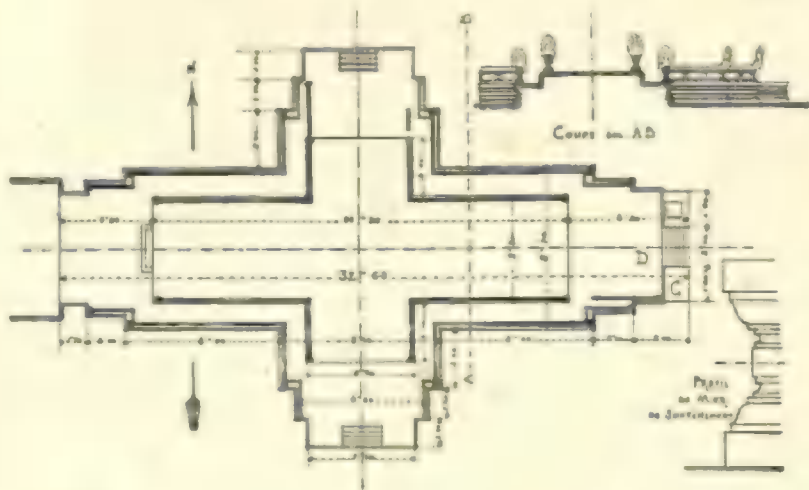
PLAN ET COUPE DE LA TERRASSE ROYALE.
